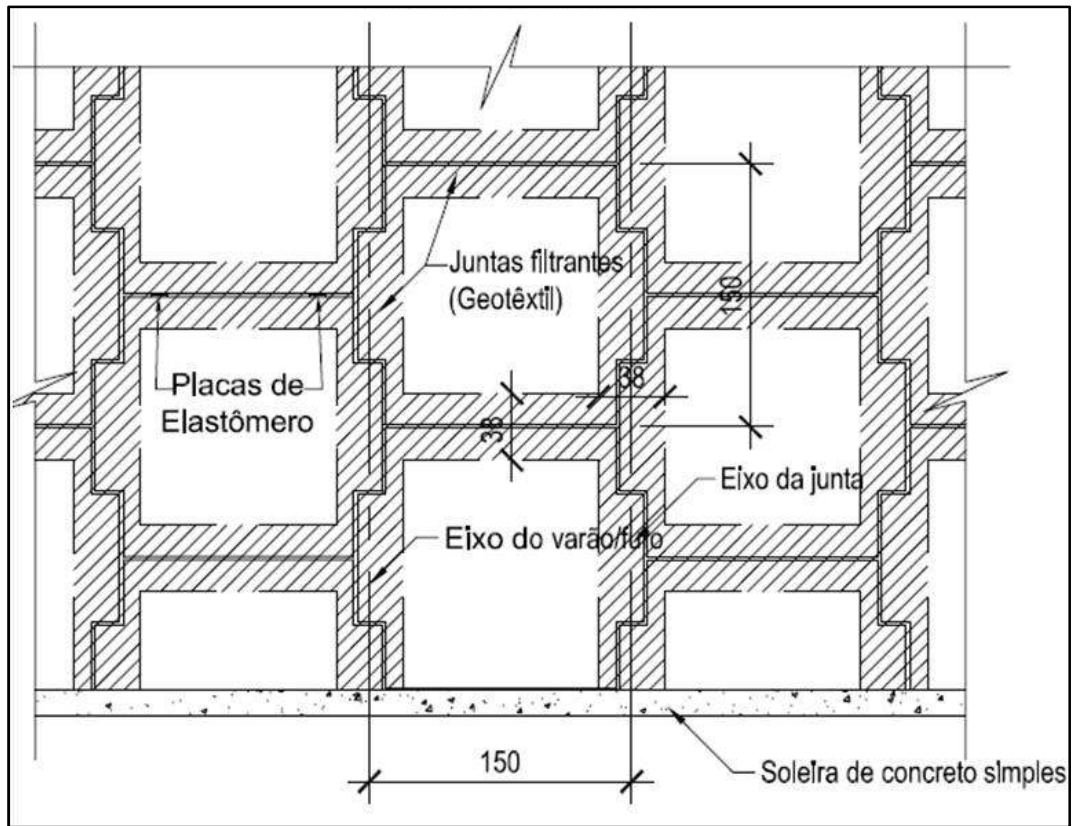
Detalhe do posicionamento das escamas da Terra Armada, vista externa
